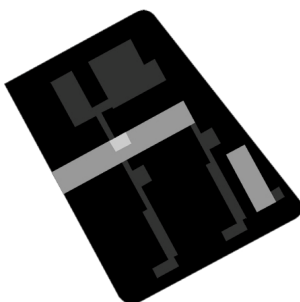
Esquema da planta de implantação da Escola Secundária Rainha Santa Isabel, em Estremoz.
